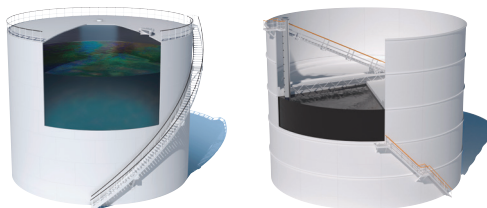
Резервуары с неподвижной и плавающей крышей.
